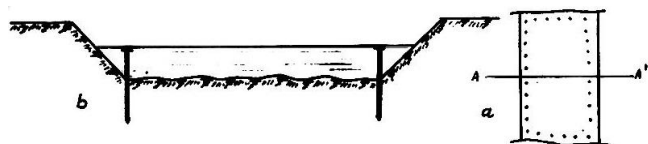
Măsurări preliminare: a – plan; b – secțiunea A-A
